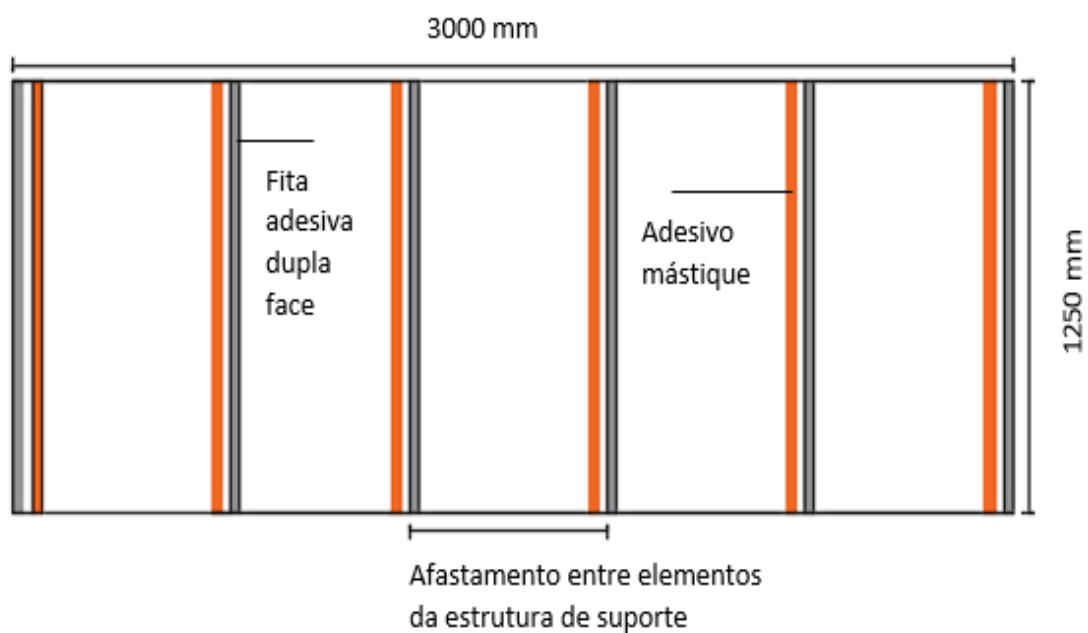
Esquema de fixação na aplicação em pavimentos
